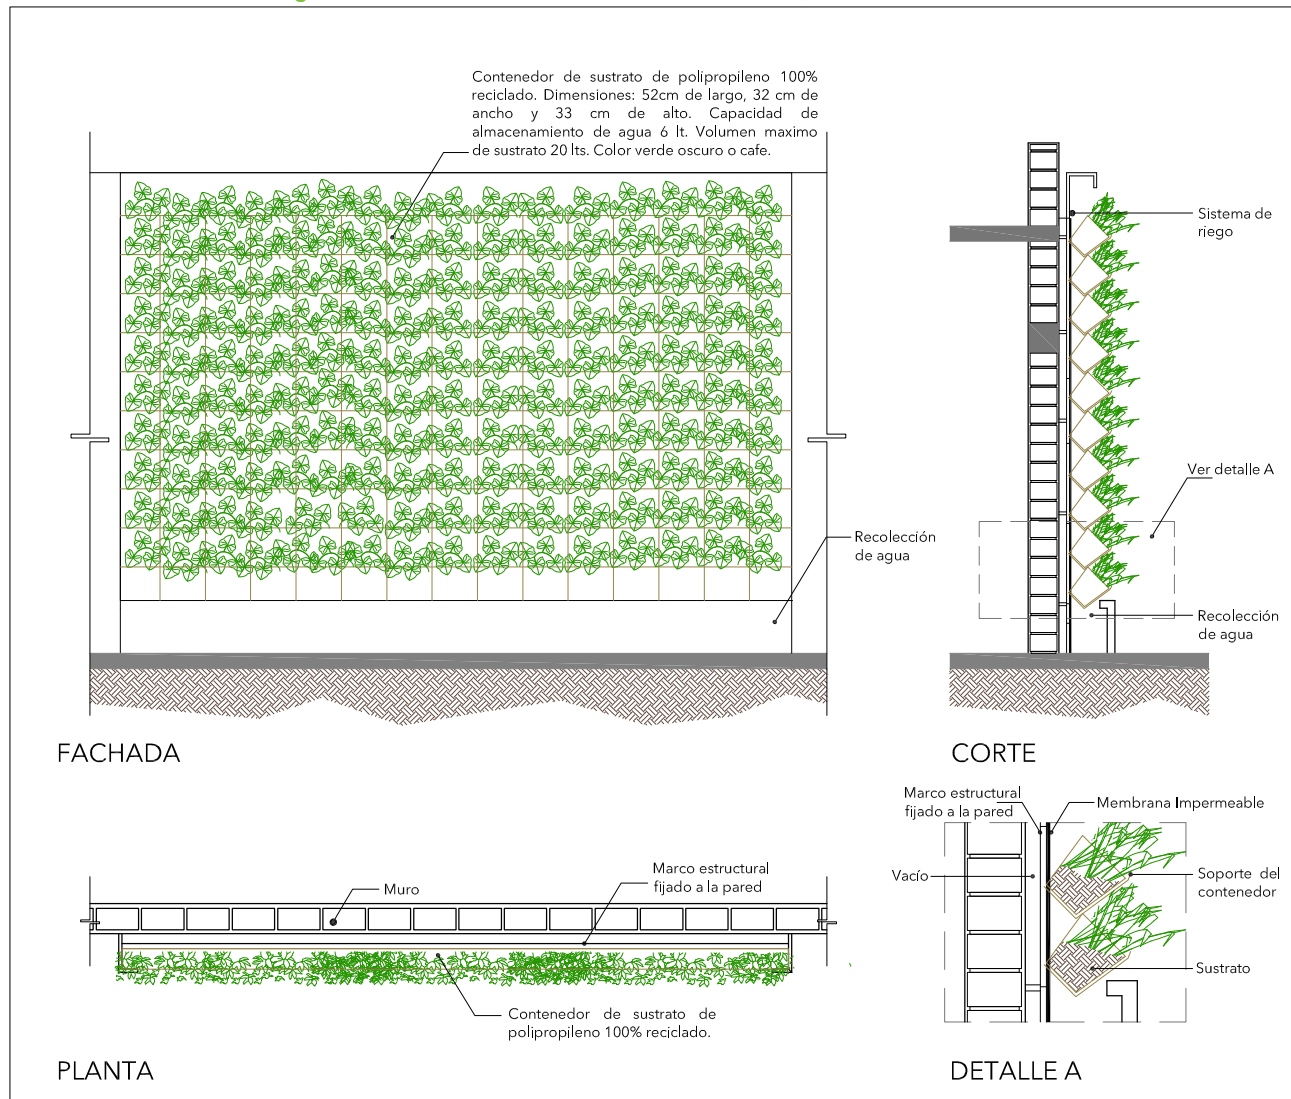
Detalles constructivos de Muro Verde, en base de sustrato
